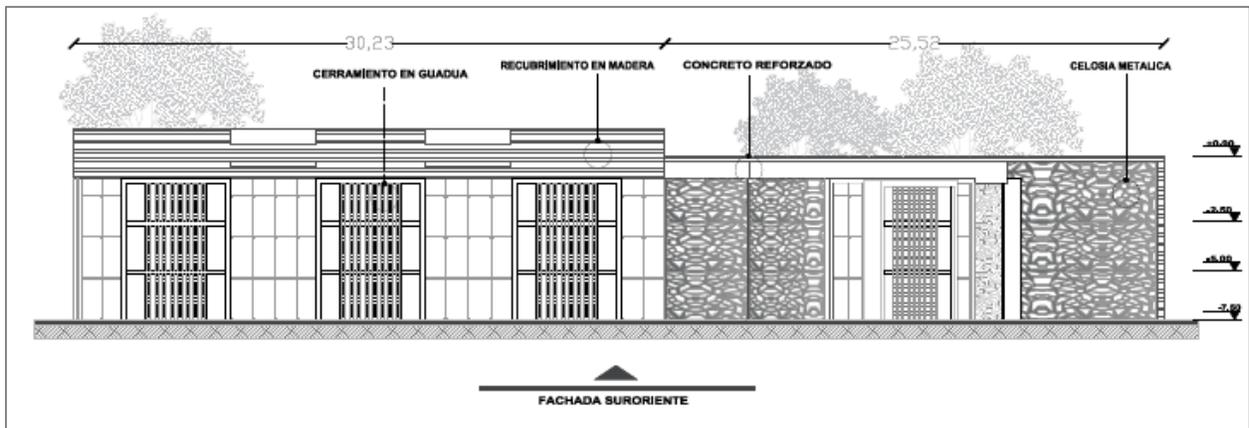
Fachada Suroriente Edificio 3 (Rubiano, 2020)
